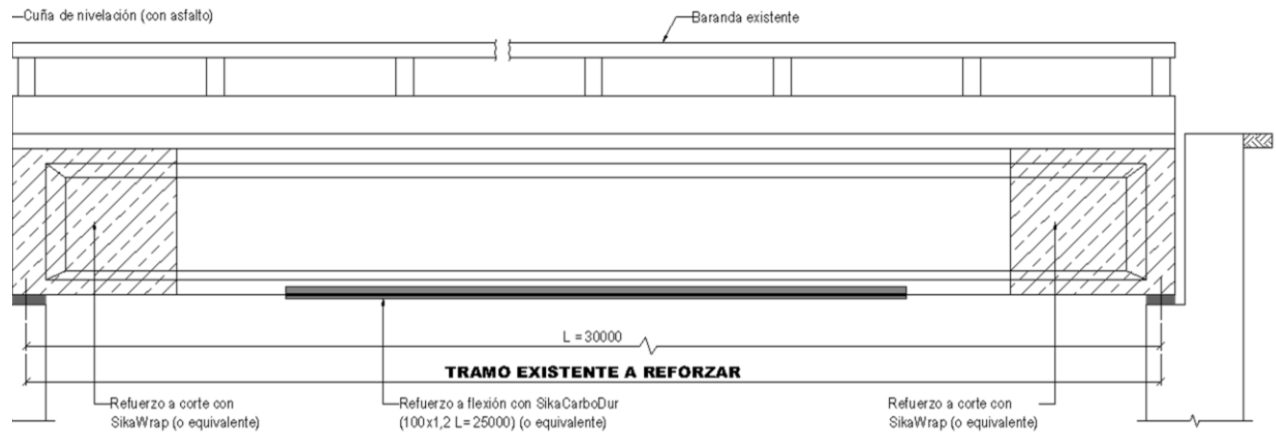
Propuesta de reforzamiento para las vigas, Sección longitudinal
